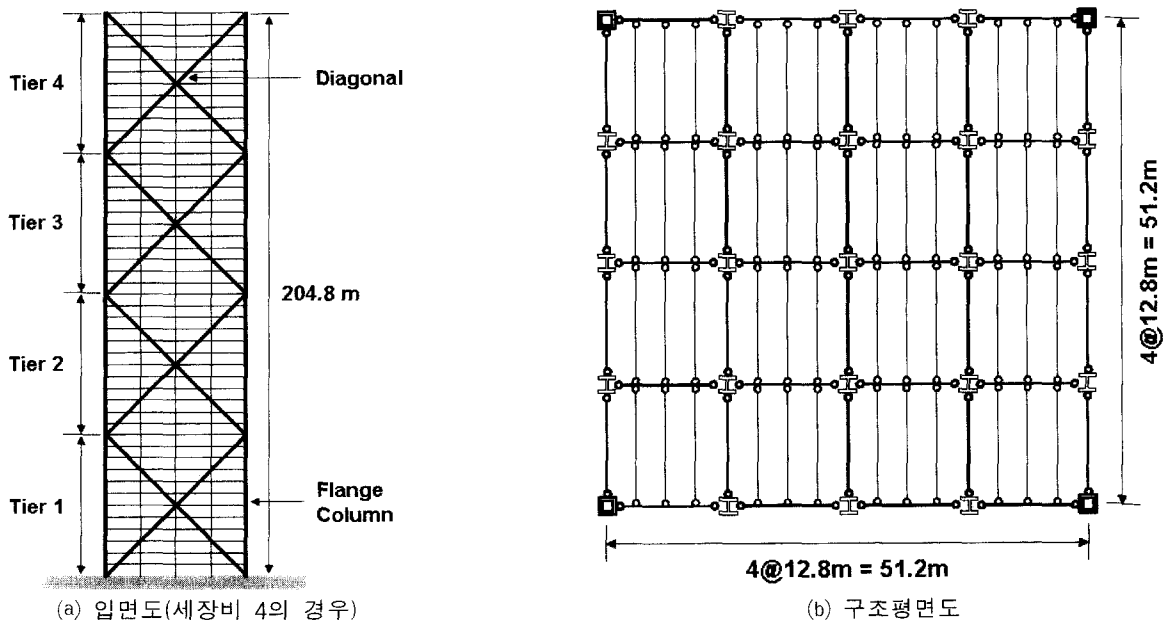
철골 중심가새골조의 구조평면도 및 입면도
